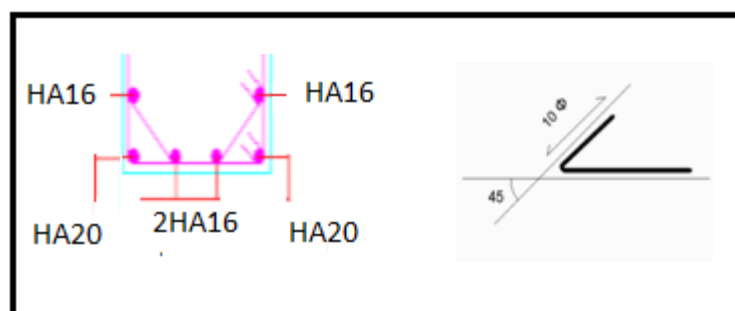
Détails sur l'emplacement des armatures des poteaux par face.
